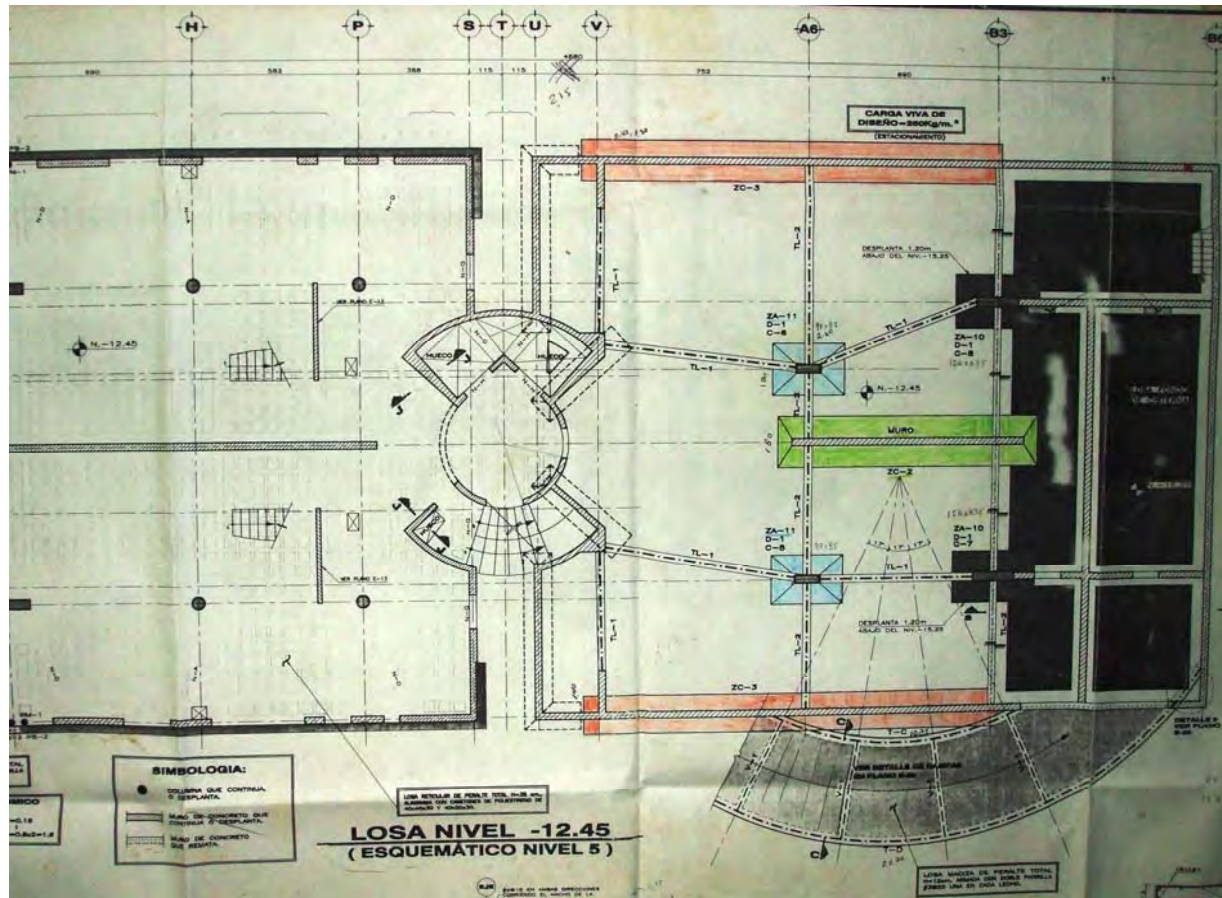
Estructural de rampa en zona inferior del plano: ejes de alfardas, traves y sombreado de losa.
